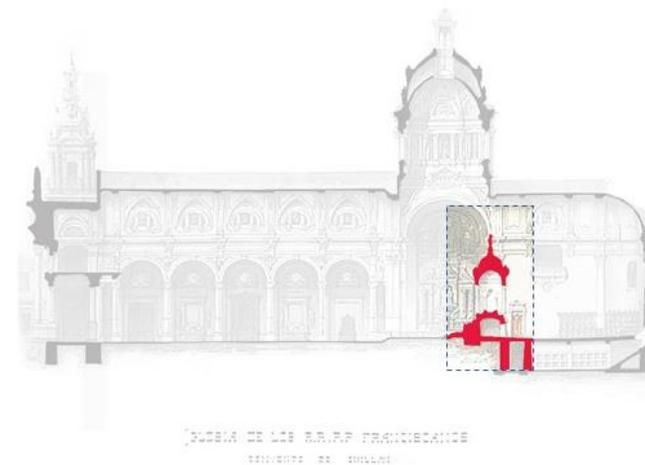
Elaboración propia sobre la planimetría original de Provasoli. Ubicación del púlpito en el interior del templo
